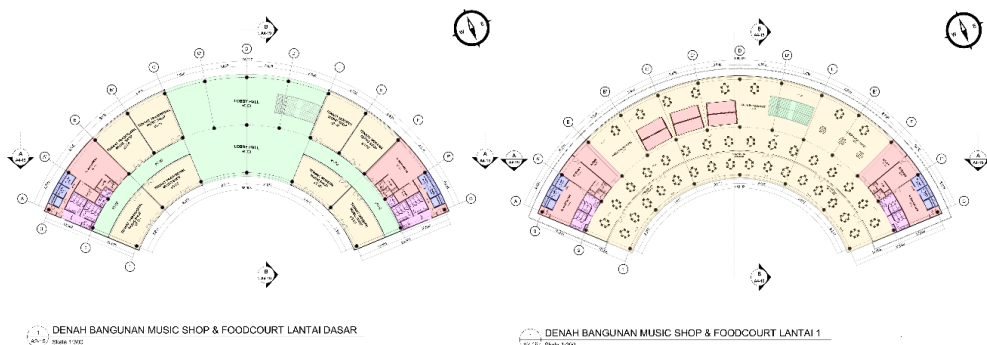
Denah Lantai dasar dan Lantai 1 Bangunan Fasilitas
